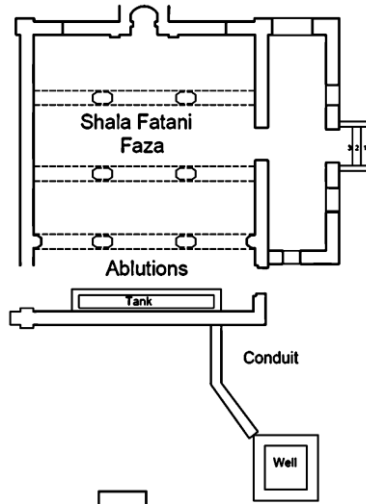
مسقط أفقي لمسجد كلوة كيسواني الصغير/تنزانيا
